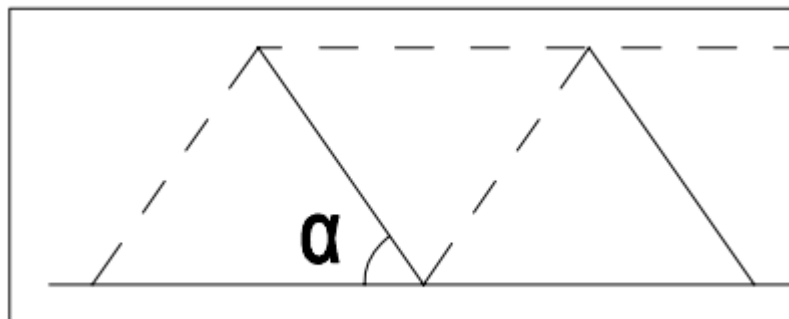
En betongbalk med armering. De streckade linjerna är tryckta stavar.
